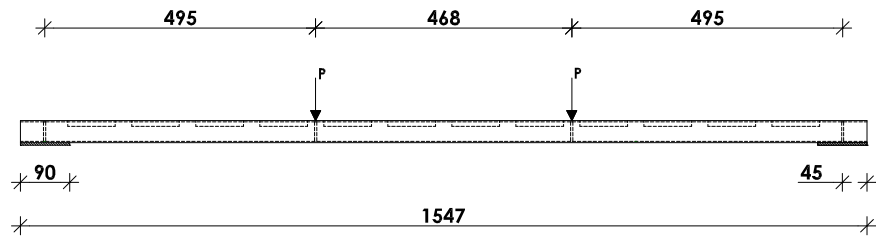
Alçado do ensaio tipo 150×1.5\_Fz2\_Furos (dimensões em mm).
